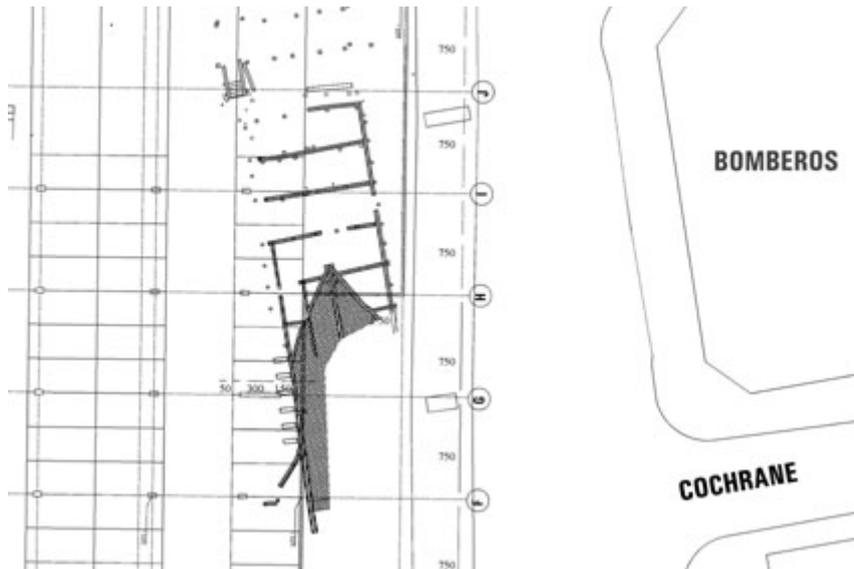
Detalle plano de planta de Plaza Sotomayor y de los estacionamientos donde se indica la ubicación precisa del muelle Esmeralda. Se marcan ejes arquitectónicos.
